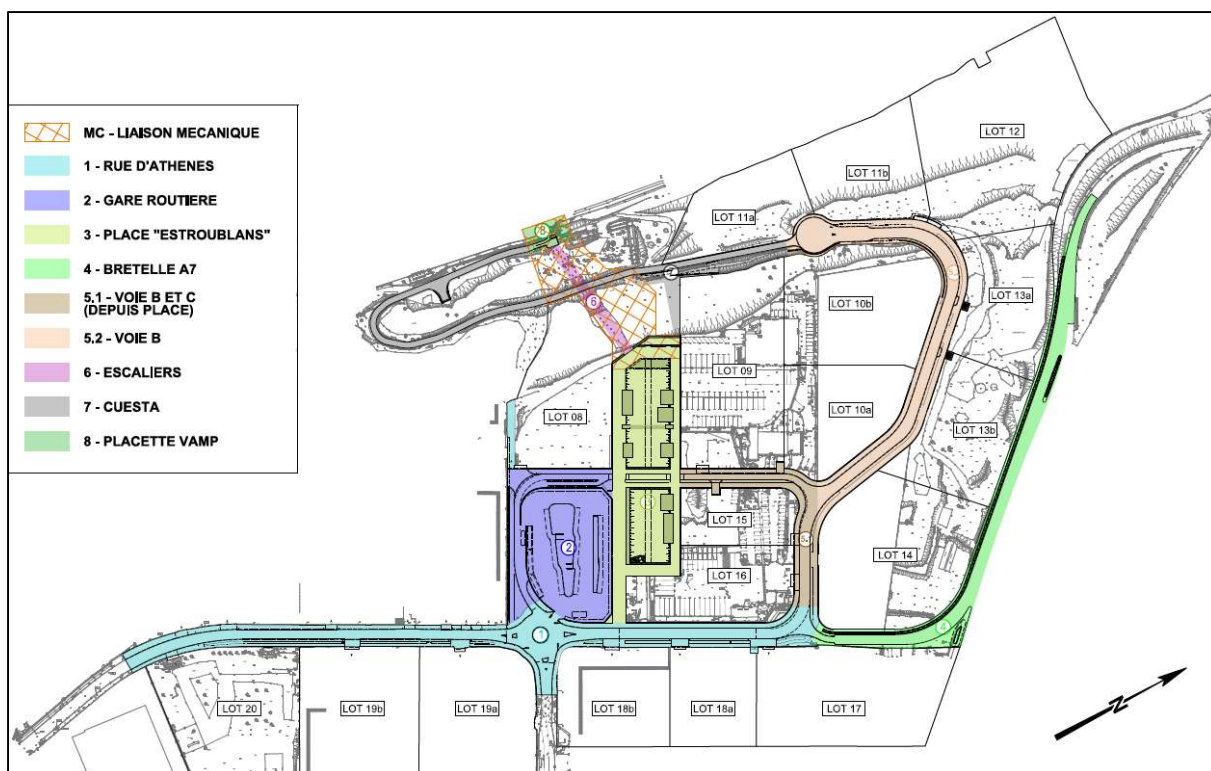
plan de situation des différents secteurs de la zone de projet (source : maitre d'ouvrage)
